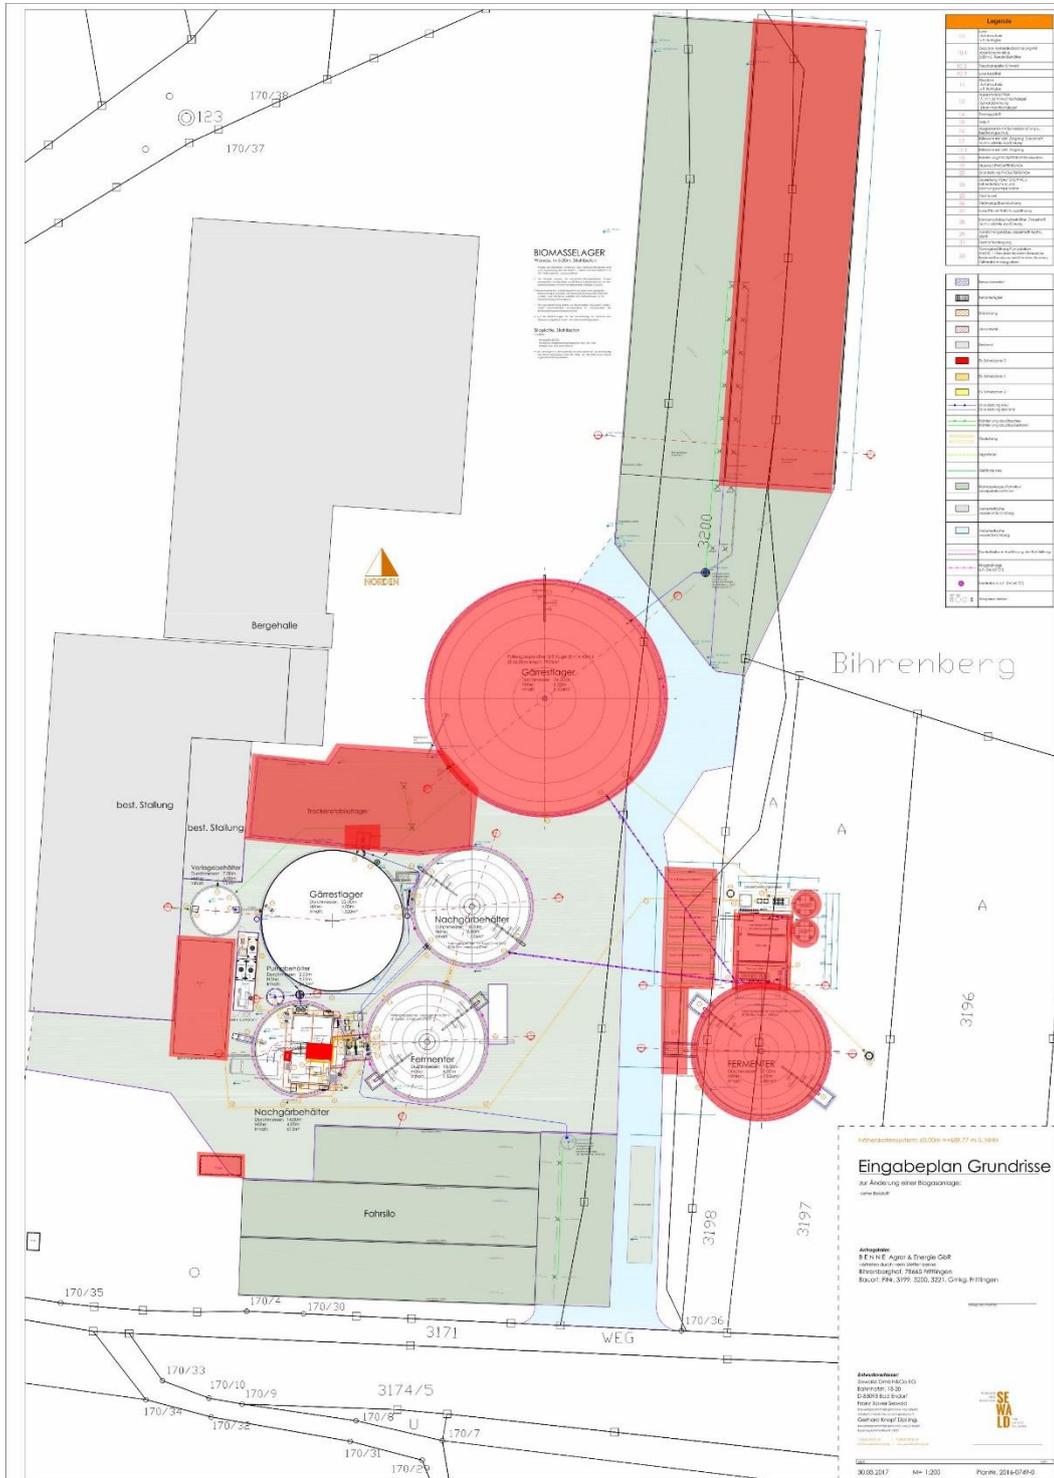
Lageplan der Biogasanlage Benne. (Plangrundlage: Sewald GmbH & Co. KG, Eingabeplan Grundrisse, PlanNr. 2016,0749-0, 30.03.2017). Neu hinzukommende oder zu ändernde Anlagenteile sind rot dargestellt.
